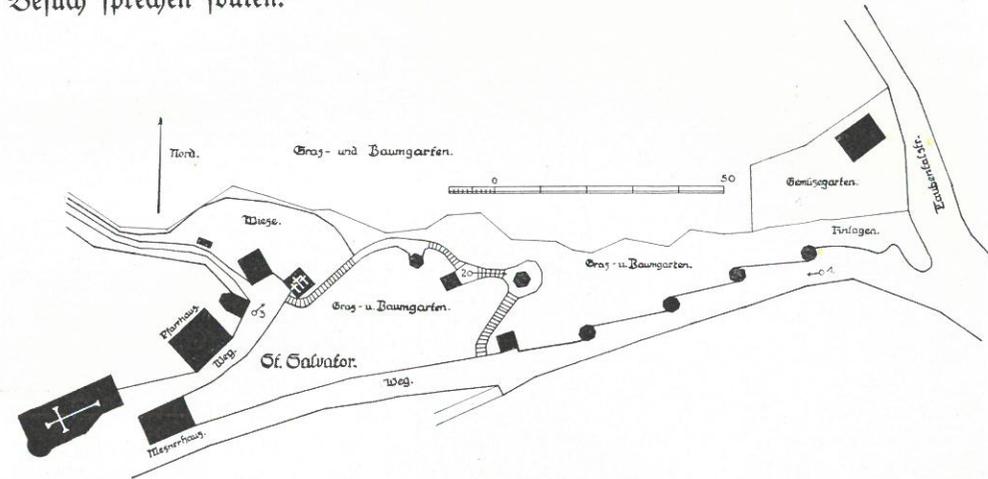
Grundriß der Stationenanlage beim Salvator in Gmünd.
